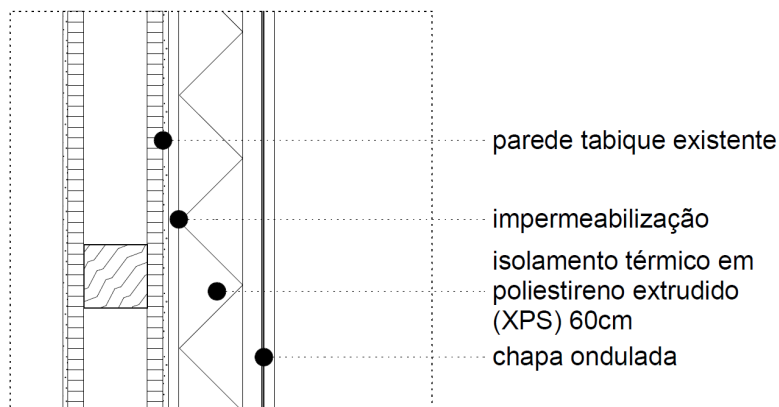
Corte esquemático das paredes exteriores em tabique.
